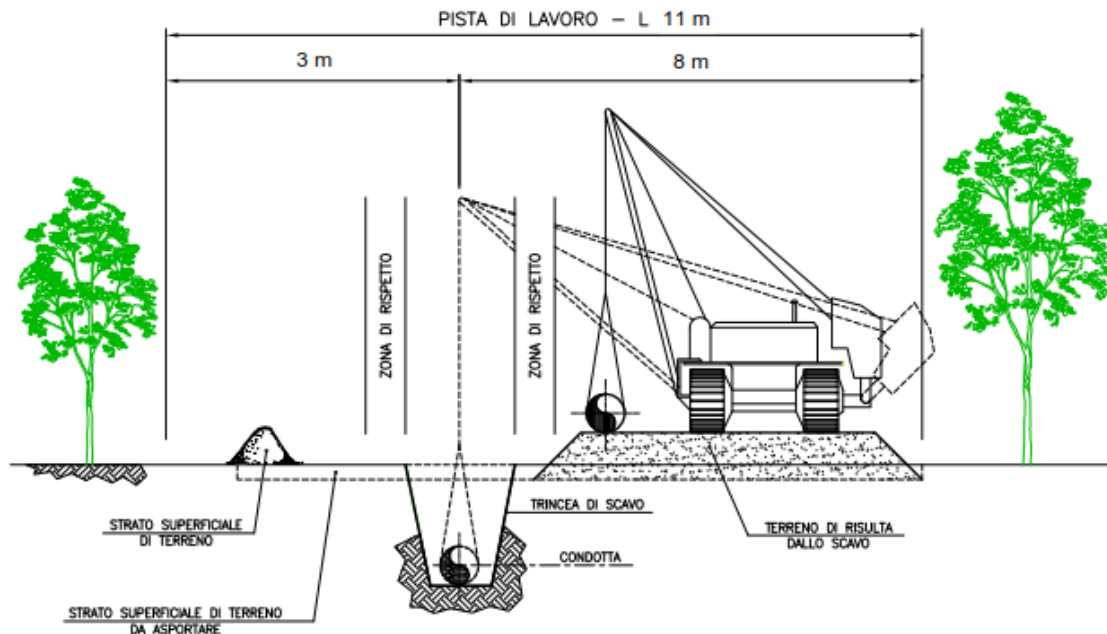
Sezione tipica - Pista di lavoro "ristretta"
